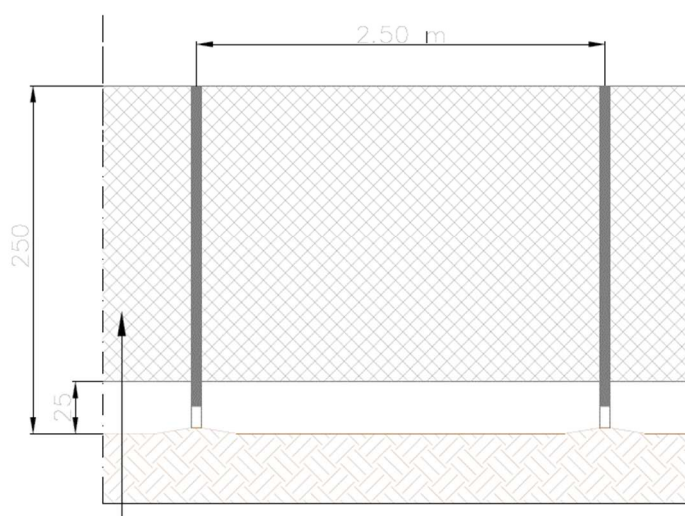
Rappresentazione della recinzione prevista di altezza pari a 2,5 m
